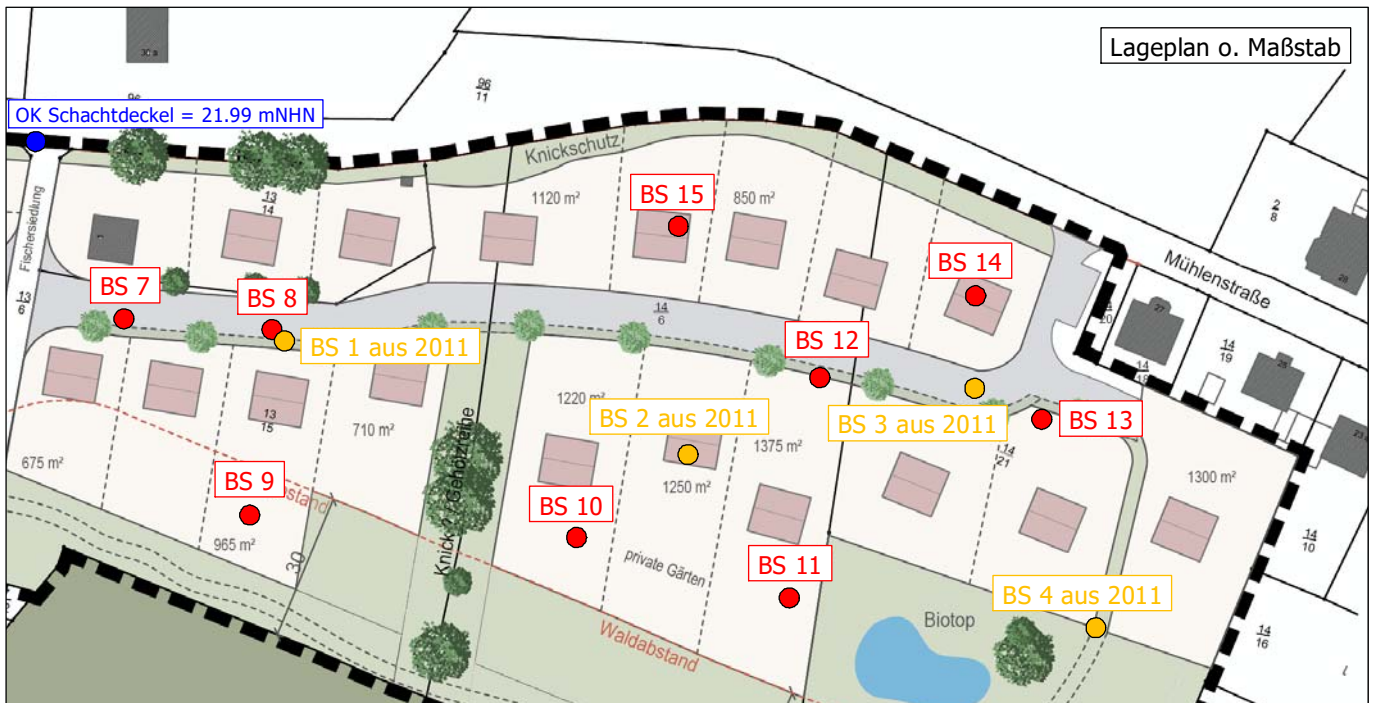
Lageplanausschnitt s. Anl. 1.2_2022, (o. M.)
